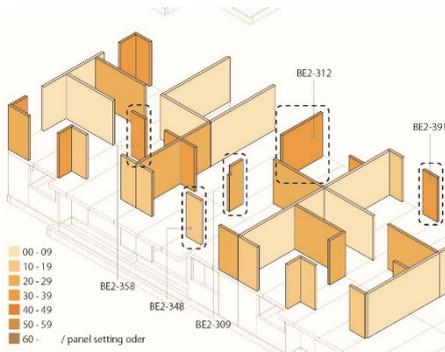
BE棟2階部分の壁パネルセット作業順序 BE 2nd floor wall panel setting order
